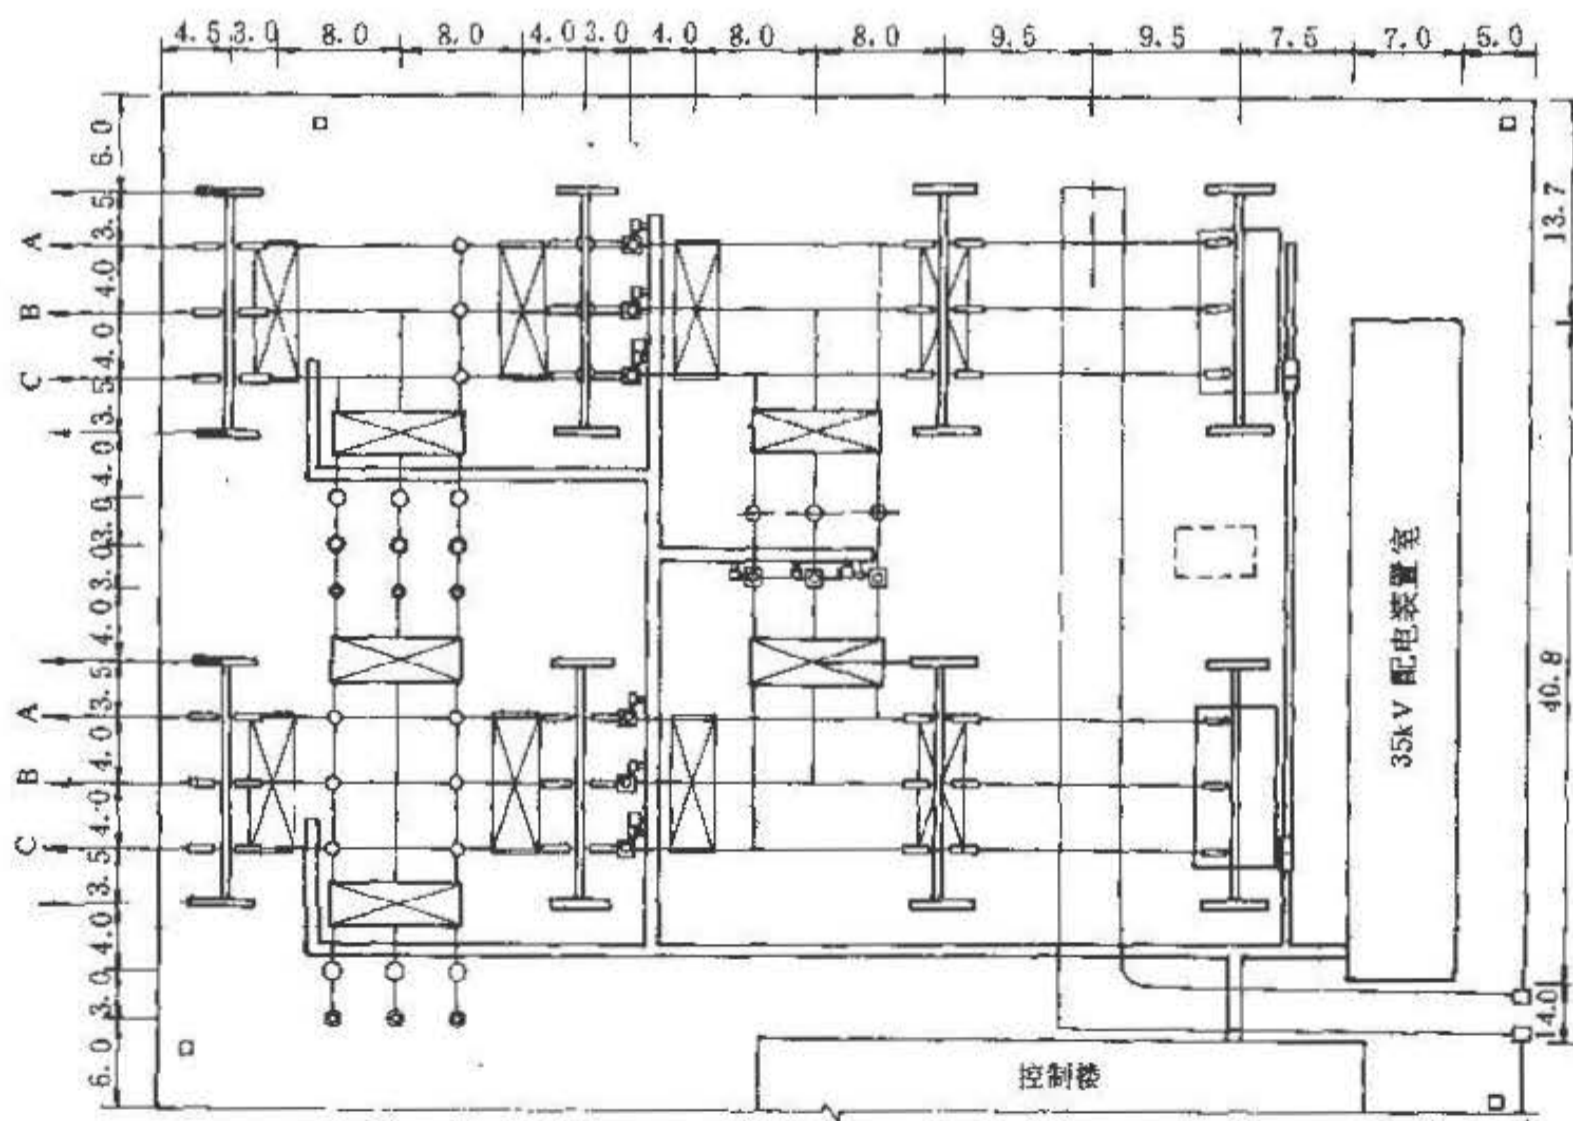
220/35kV 变电所总平面图 (图中单位为 m)
